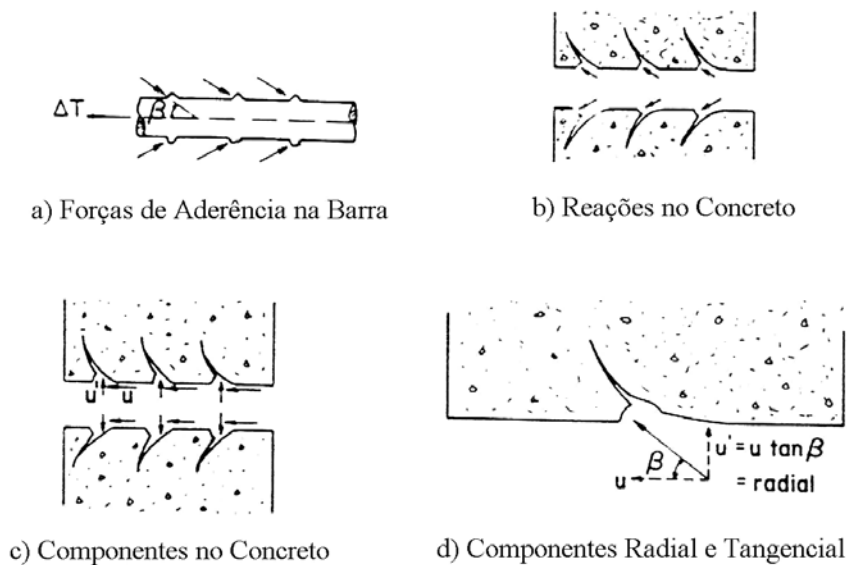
Forças entre o concreto e a barra nervurada (ORANGUN *et al*, 1977).
